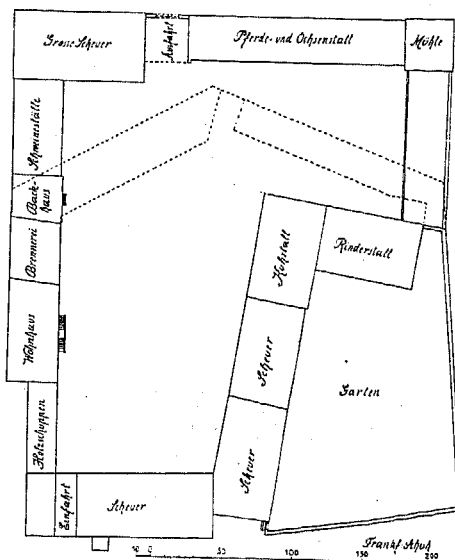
Hof Rebstock; Grundriss im Jahre 1851. Nach Akten des Bauamtes.
